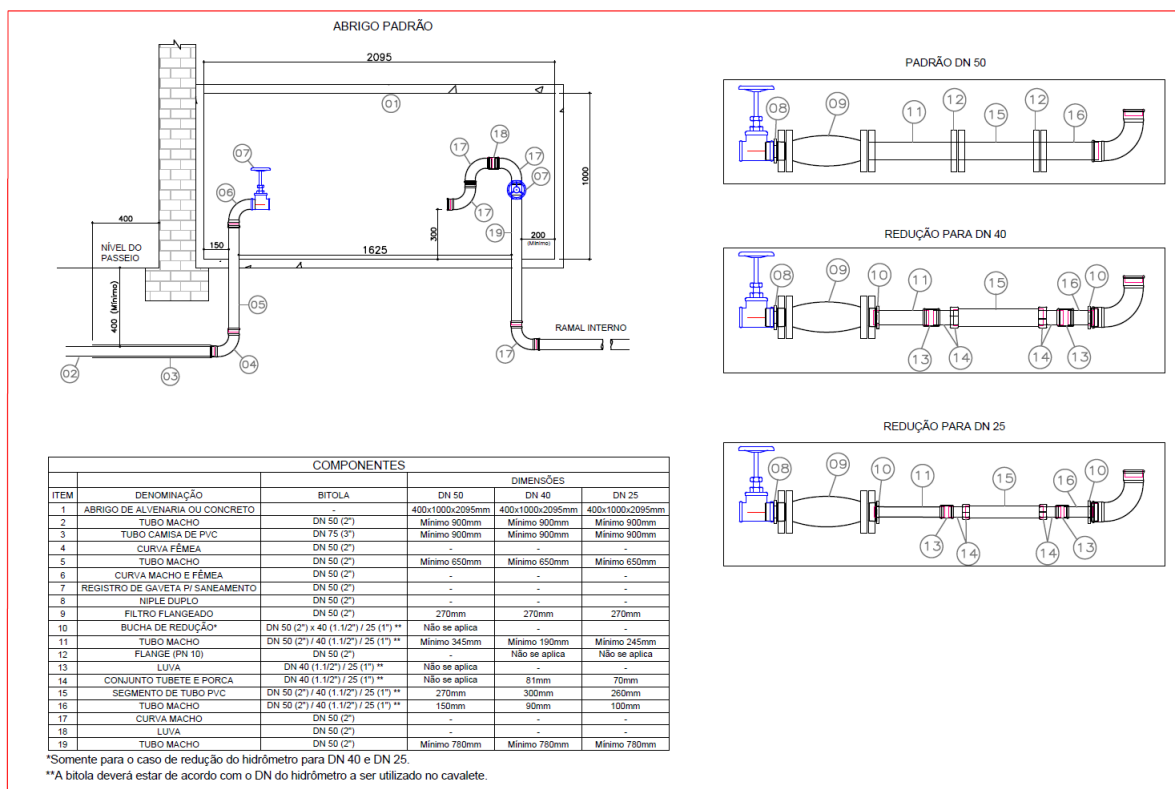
Modelo de montagem para cavalete DN 50 com alternativa de montagem para instalação de hidrômetros DN 40 e 25 (adequação).
